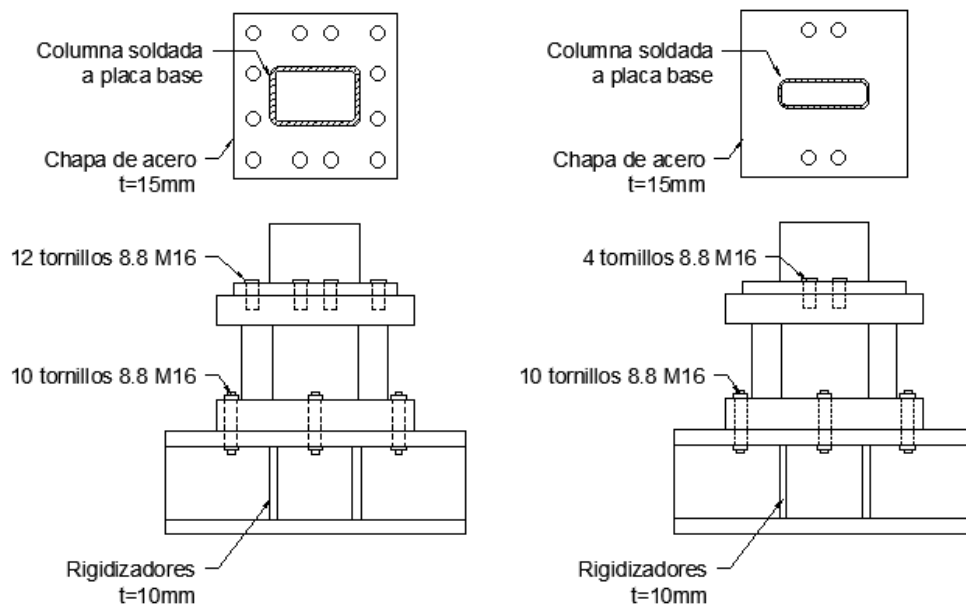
Apoyo empotrado (S1 y S2, izquierda) y apoyo articulado (S3 y S4)
